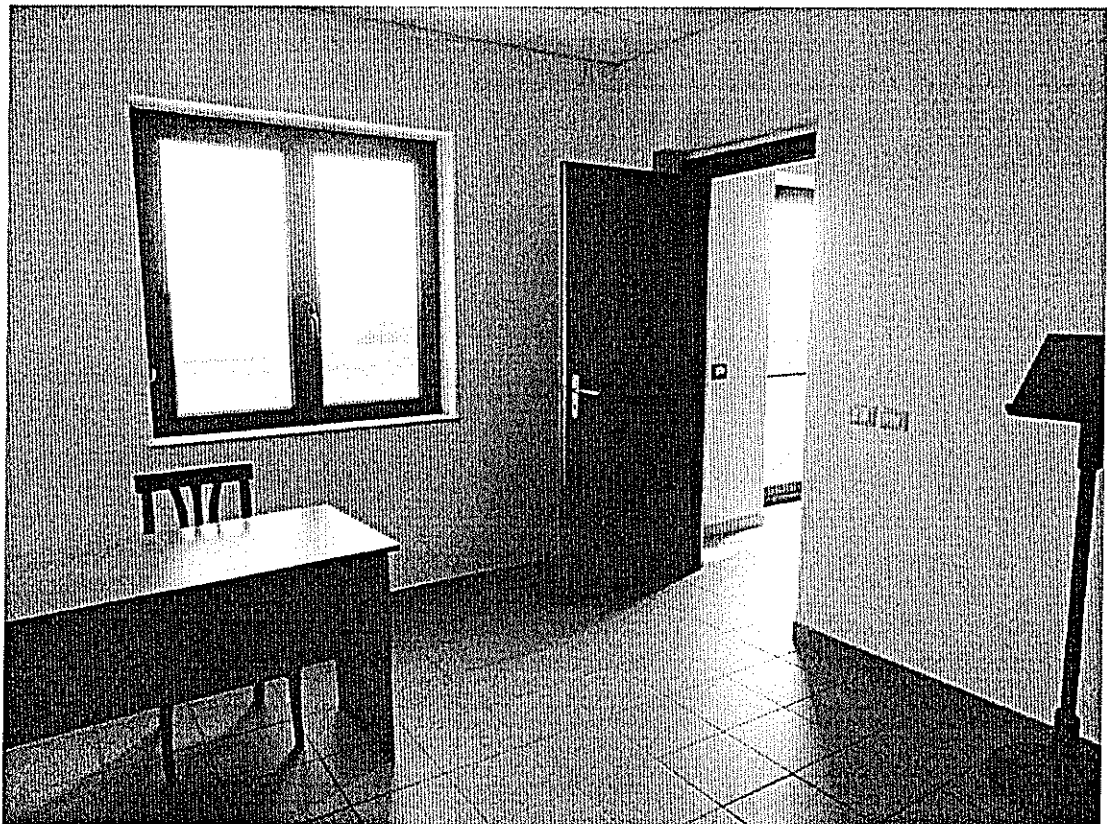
Locale per il personale del primo corpo di fabbrica – piano terra.
